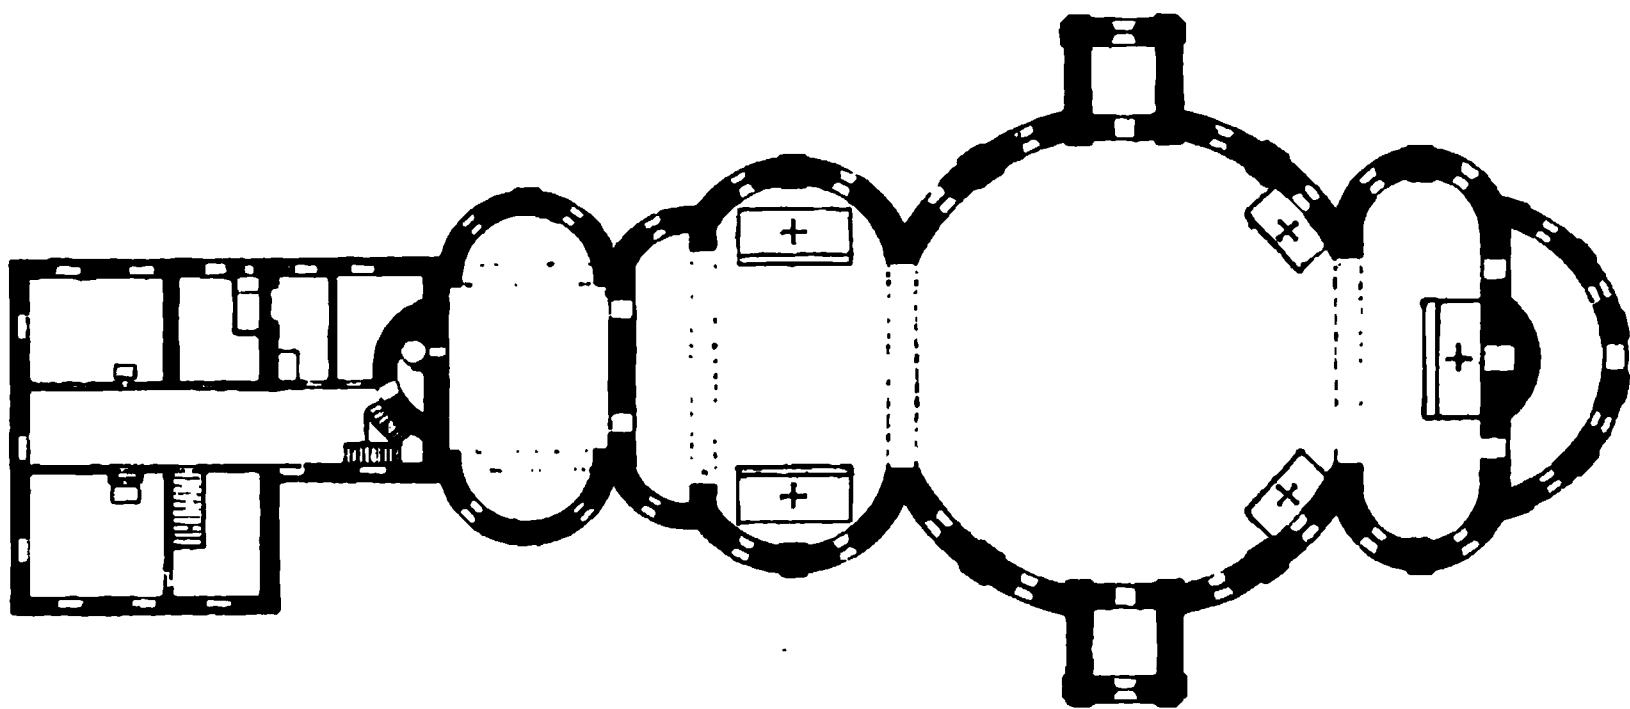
Grundriß der Wallfahrtskirche zu Maria-Birnbaum mit der alten Altarstellung und dem Benefiziatenhaus vor 1868.
